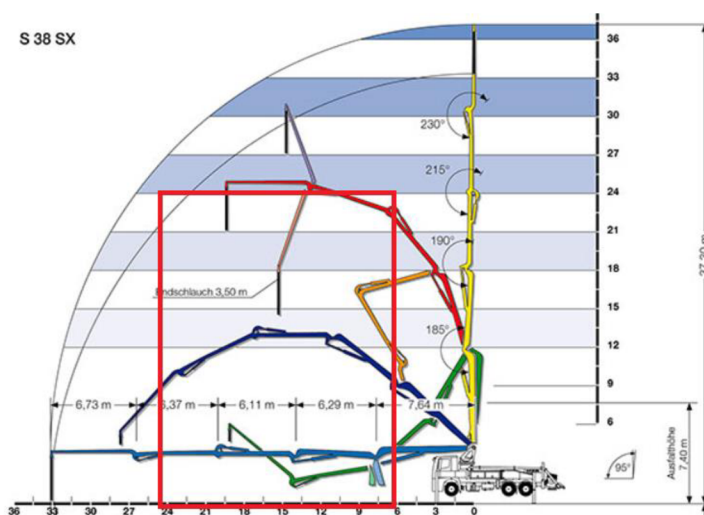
Autočerpadlo SCHWING s výložníkem S38 SX REPTOR
